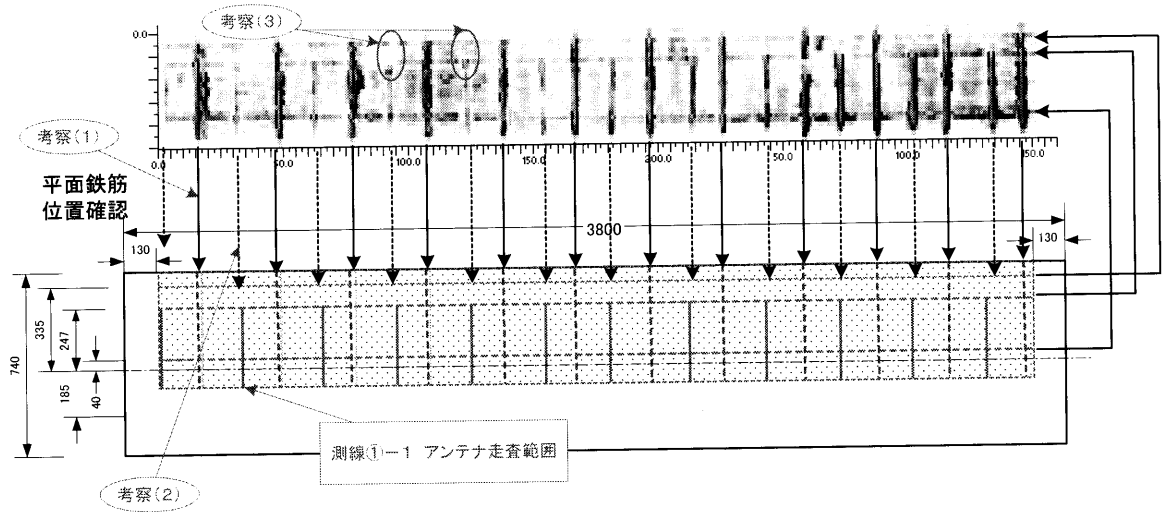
供試体①／測線①-1 平面透過画像
